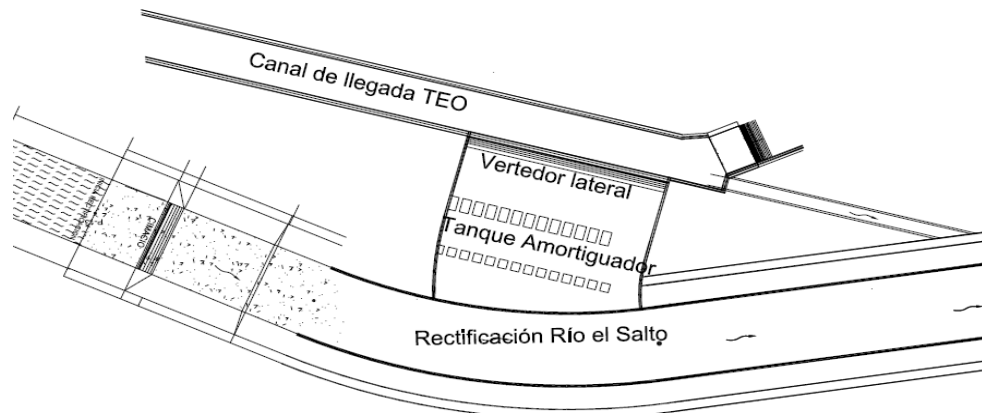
Vista en planta modelo físico portal de salida oriente.
